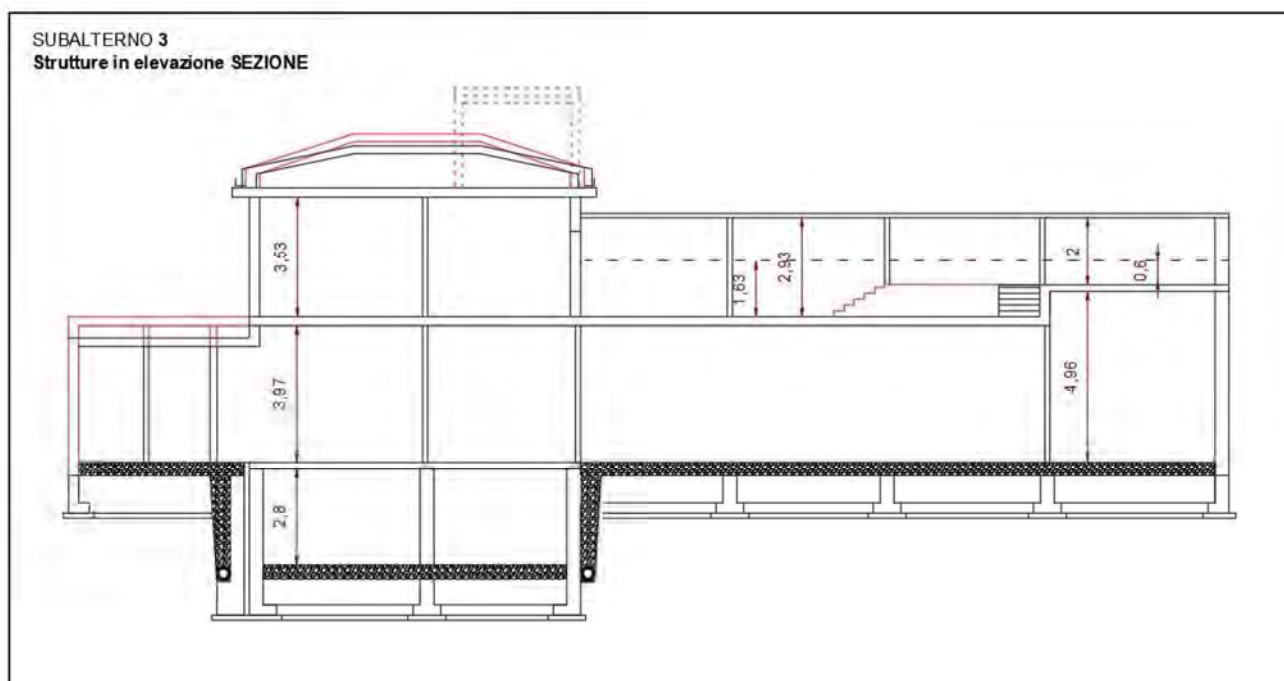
Sezione - Difficoltà tra progetto in variante e stato di fatto rilevato durante il sopralluogo del 07.02.2019
